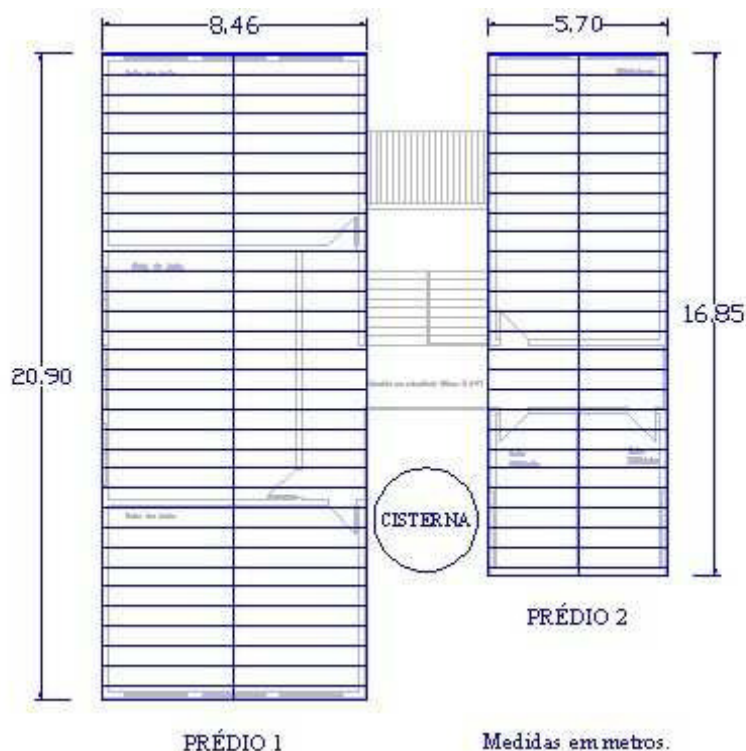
Planta de telhado dos prédios 1 e 2 (Ouriques *et al.*, 2008).
